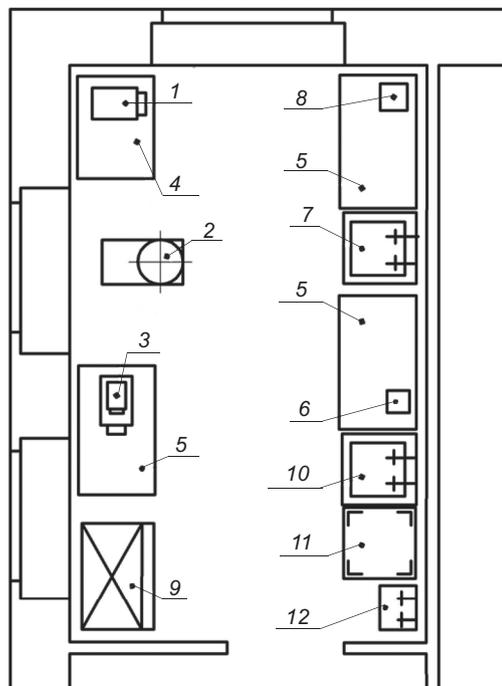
Планировка рыбного цеха заготовочного предприятия:
